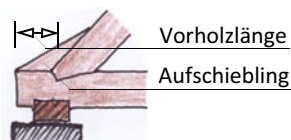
Fußpunkt: einfaches Sparrendach
